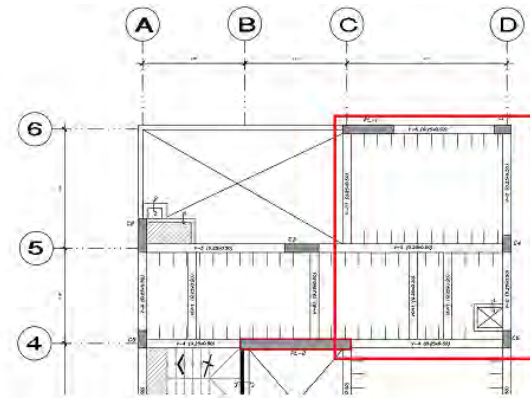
Acercamiento a los ejes 4-6 y C-D en el plano de estructuras
